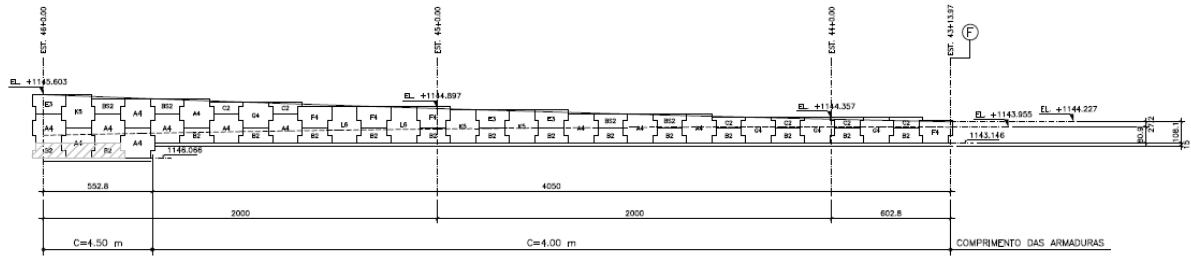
Elevação Solo Reforçado Eixos EF-3
